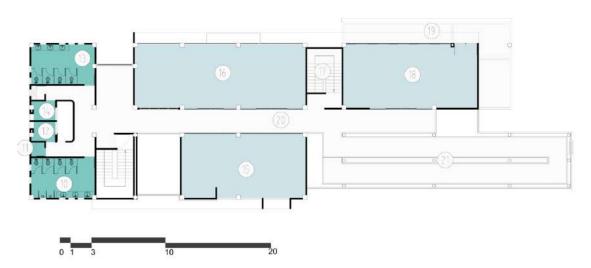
Planta 2 Bloque 54. Fuente: Equipo de diagnóstico.
